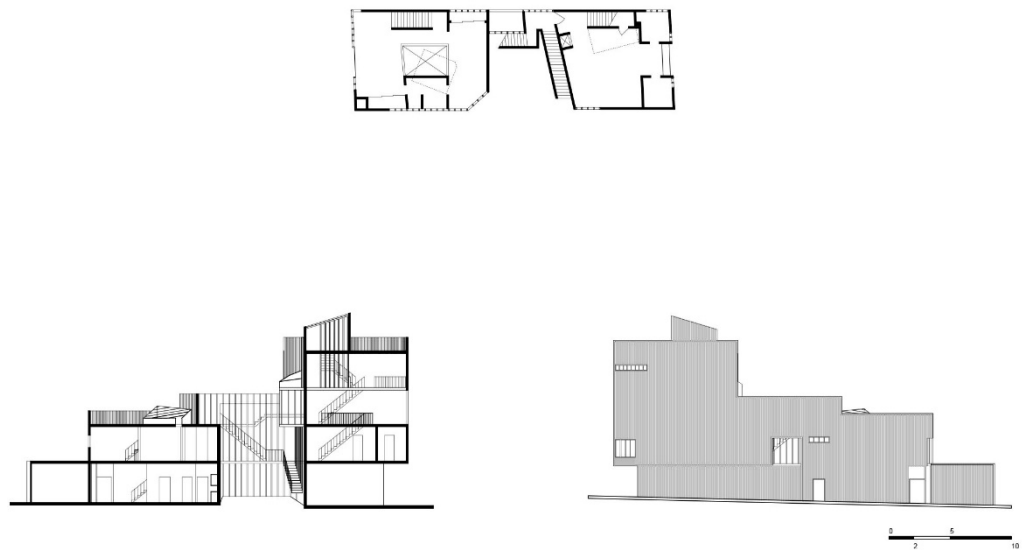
Redesenho da planta, corte e elevação – Casa Spiller
